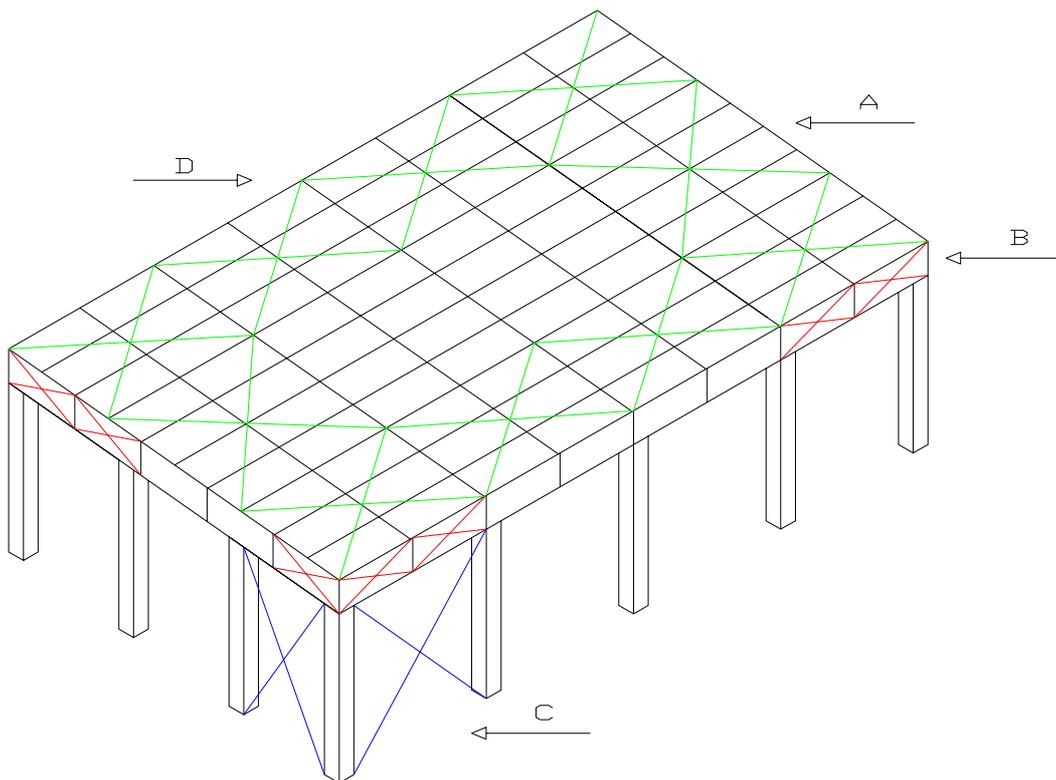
Edifícios industriais: A) Viga horizontal de apoio dos pilares de fachada e de fixação das madres (que por sua vez garantem o contraventamento dos banzos superiores das vigas); B) Contraventamento das vigas metálicas; C) Elementos de rigidez dos pórticos de fachada; D) Viga horizontal de apoio dos pilares.
